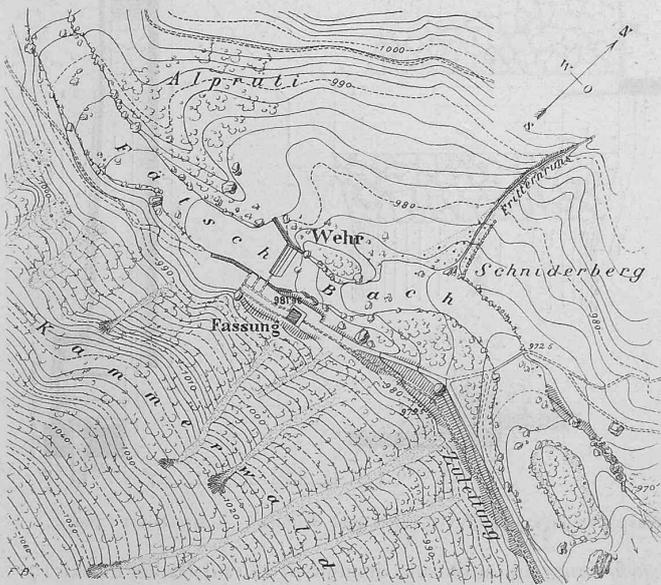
Lageplan der Wasserfassung. — Masstab 1 : 2000.
